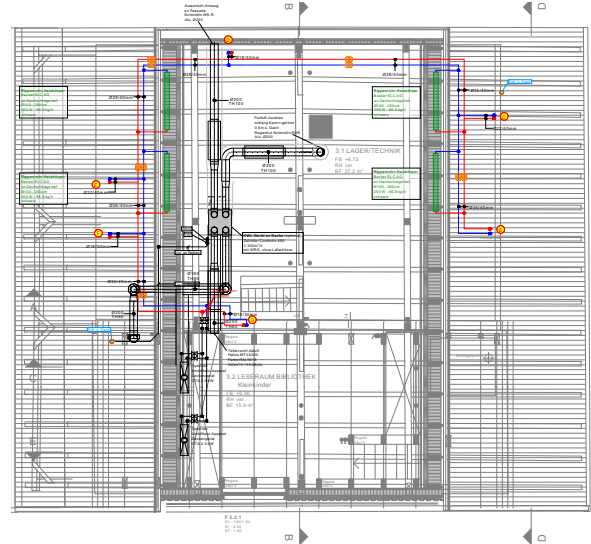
Grundriss 3. OG Koordinationspläne
